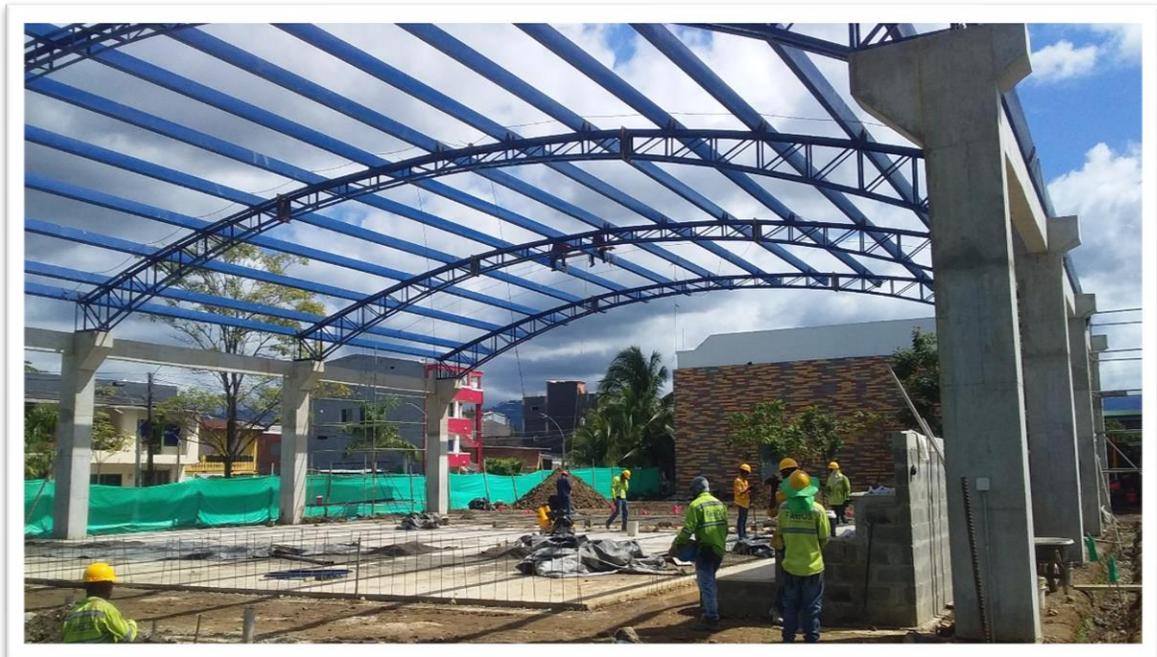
columnas, vigas aéreas, losa de contrapiso deportiva, estructura metálica de soporte de cubierta. Fuente: propia.
